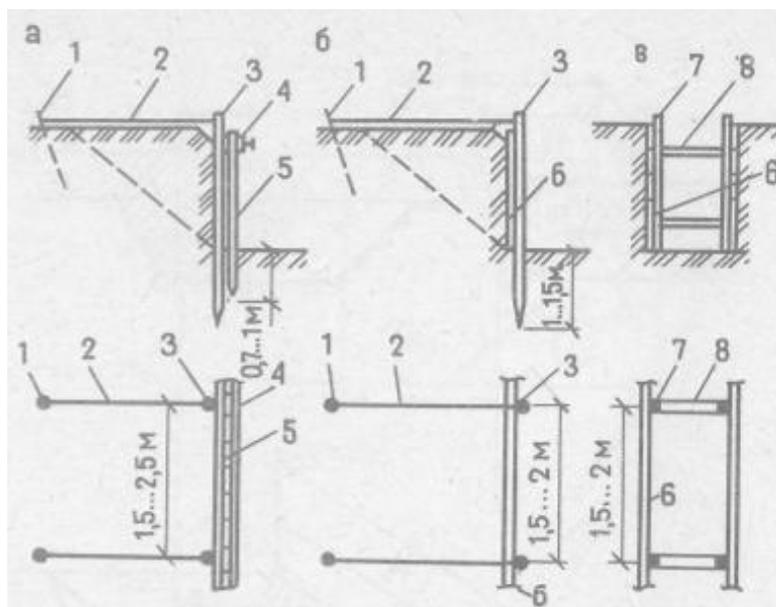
Крепление стенок шпунтом (а), щитами с опорными стойками (б), щитами с опорными рамами: 1 – анкерная связь; 2 – оттяжка; 3 – опорная стойка; 4 – направляющая; 5 – шпунтовое ограждение; 6 – щиты; 7 – стойка распорной рамы; 8 – распорка.
